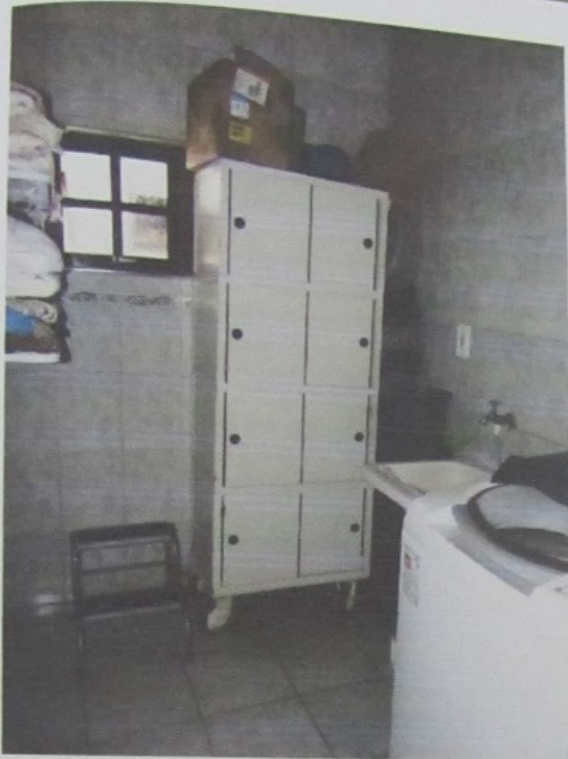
Vista interna da edificação de interesse - ambiente lavanderia.
